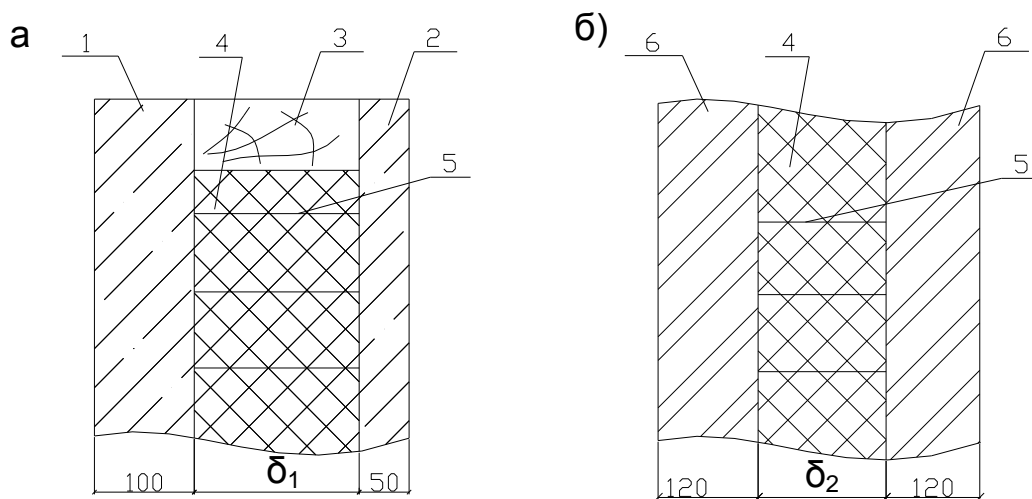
К теплотехническому расчету ограждающих конструкций: а – трехслойная панель, б – облегченная кладка; 1 – наружная железобетонная плита, 2 – внутренняя железобетонная плита, 3 – антисептированный брус, 4 – пенополистерол, 5 – гибкие связи, 6 – кирпич глиняный М75
